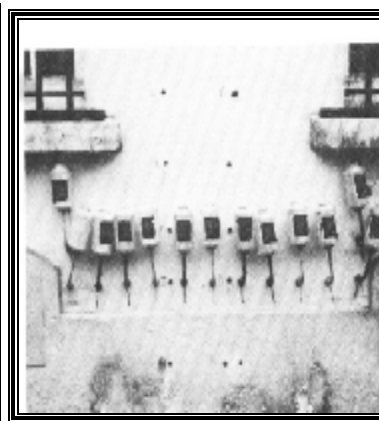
travaux d'imperméabilisation au niveau de la façade
